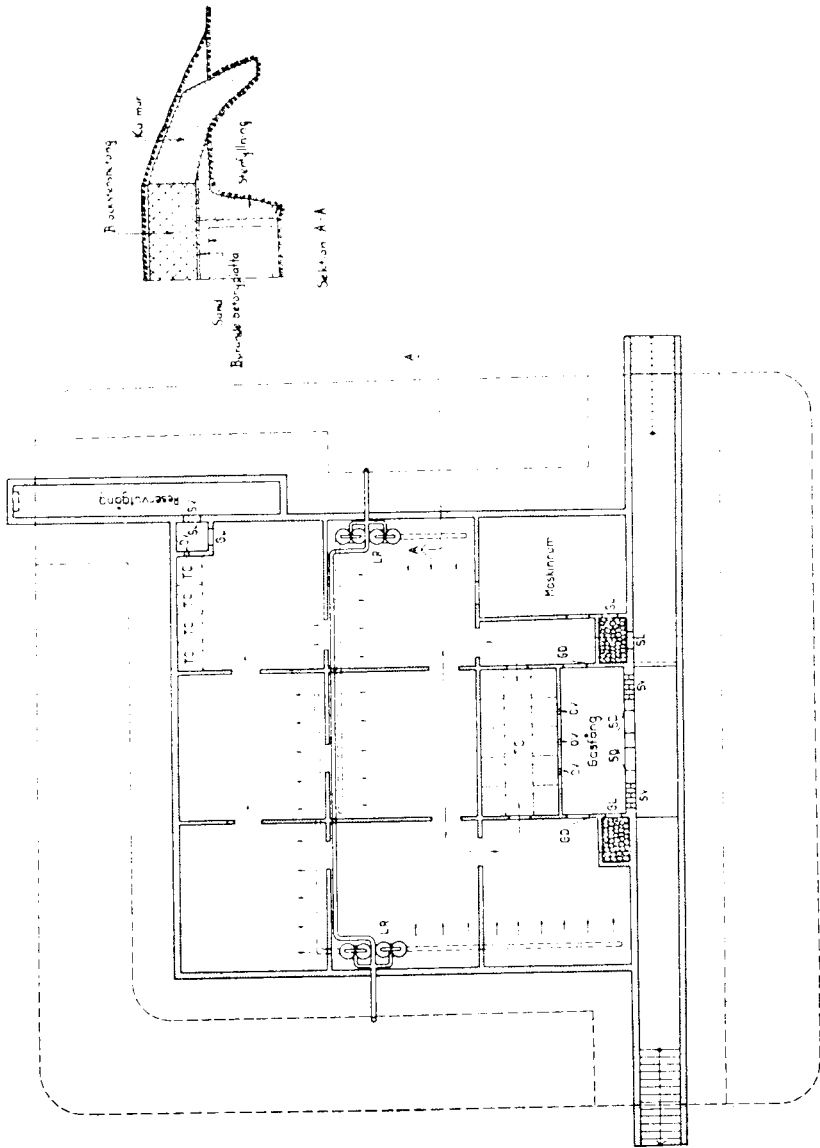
Plan o-b sektion över friliggande fullträffsäker skyddsrumsanläggning med täckande betongkonstruktion.
